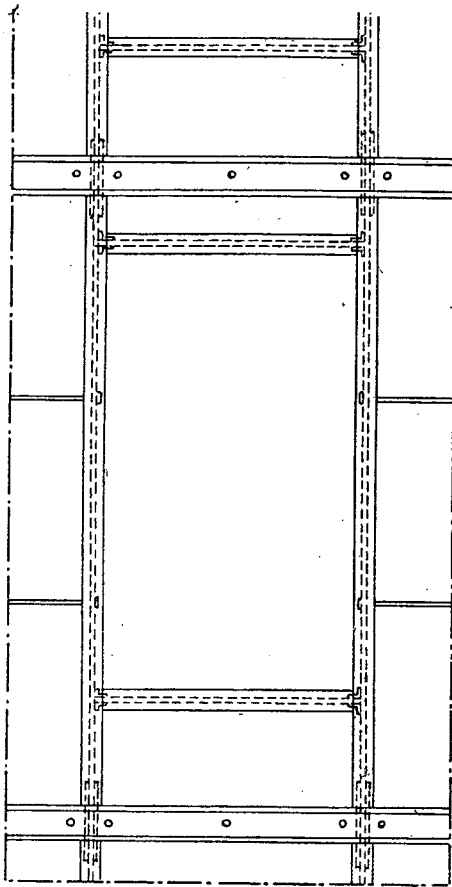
Alzado de un vano, en los entramados metálicos.
